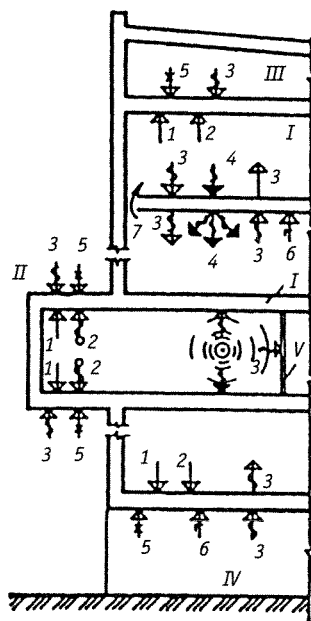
Схемы распределения воздействий среды на перекрытия и перегородки:
